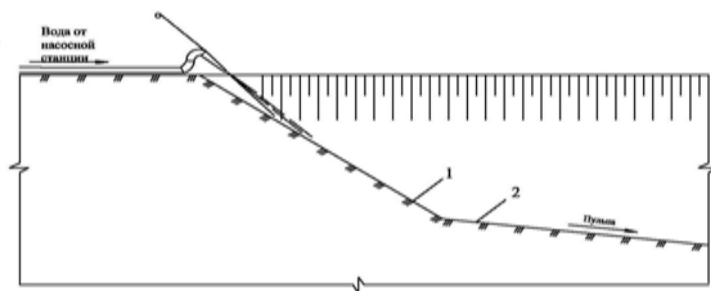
Схема размыва грунта попутным забоем: 1- откос забоя; 2 – подошва забоя
